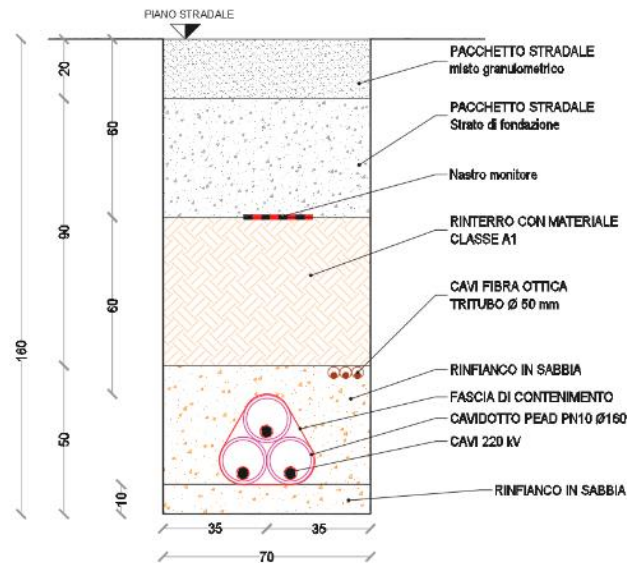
Sezione tipo cavidotto AT interrato su strada asfaltata
